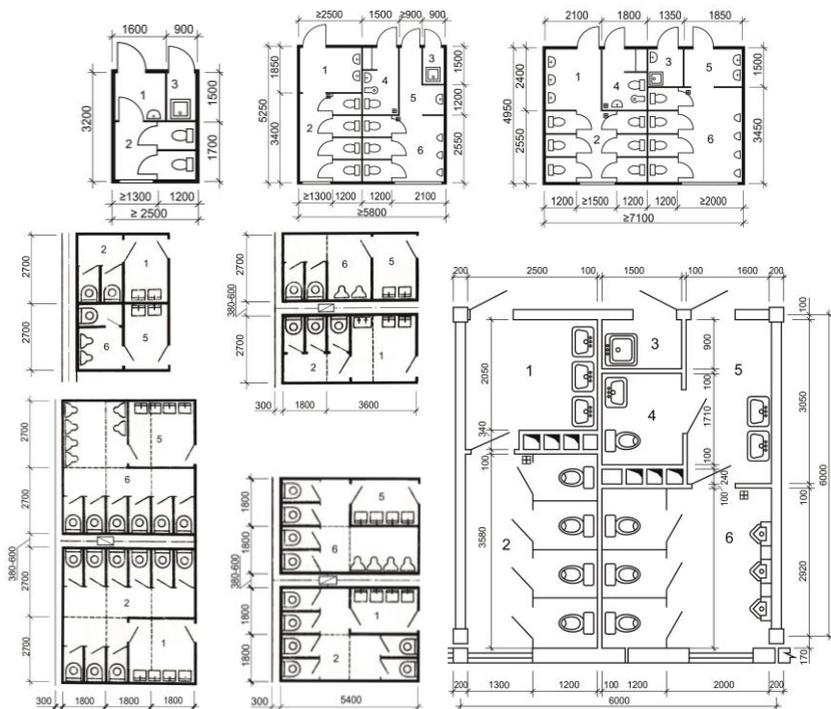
Варианты планировочных схем санитарных узлов:
